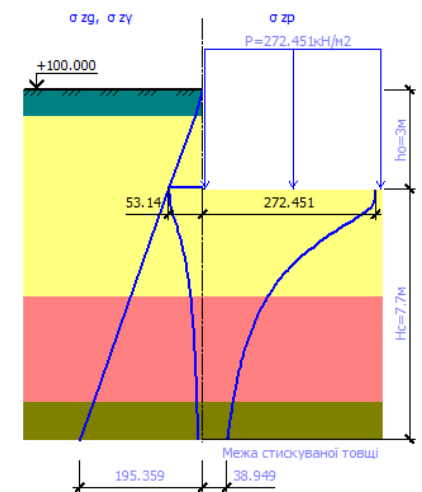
План фундаментів та їх геологічний розріз в системі ГРУНТ
